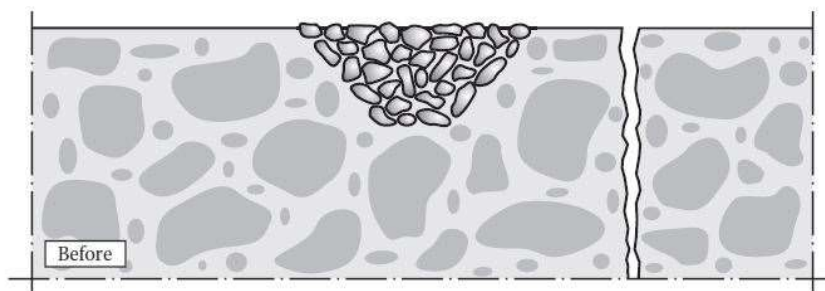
Exemplificação de danos típicos em estruturas de betão armado (RAUPACH, BUTTNER 2014).
